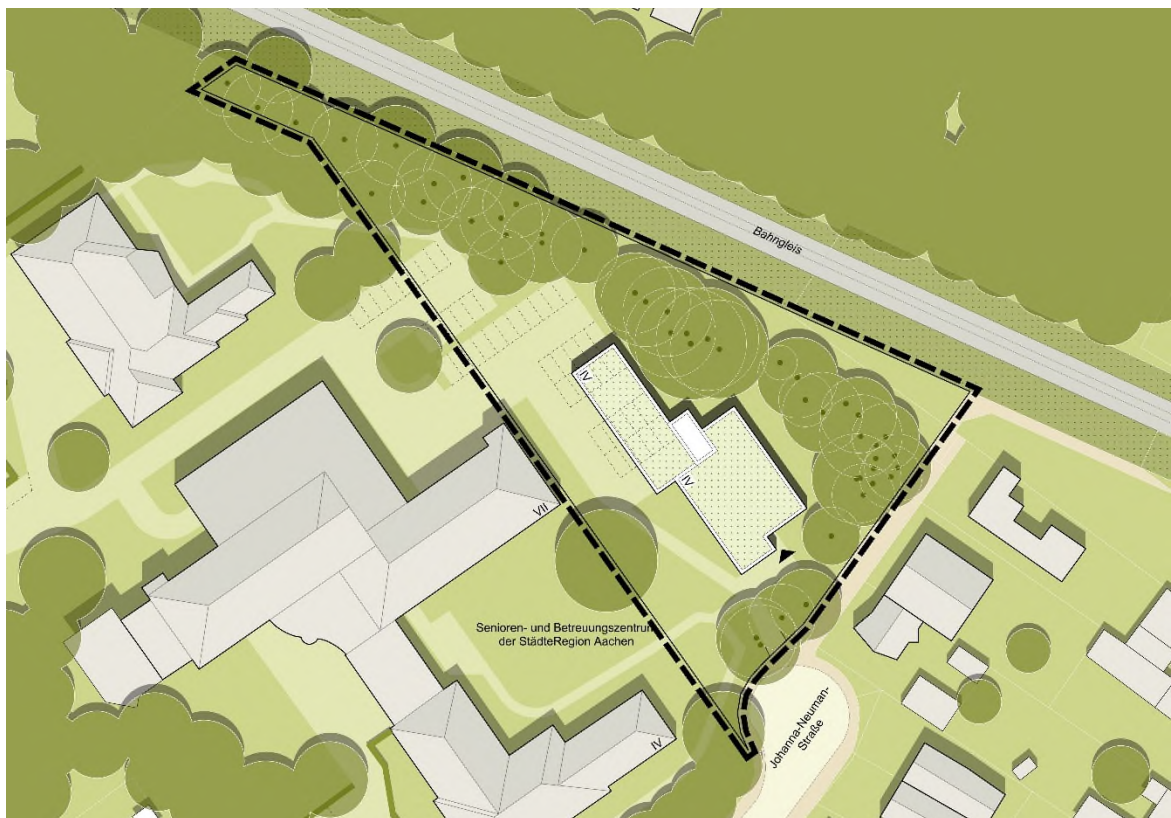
Städtebaulicher Entwurf [Quelle: APB Architekten, Stand 03/2025]
